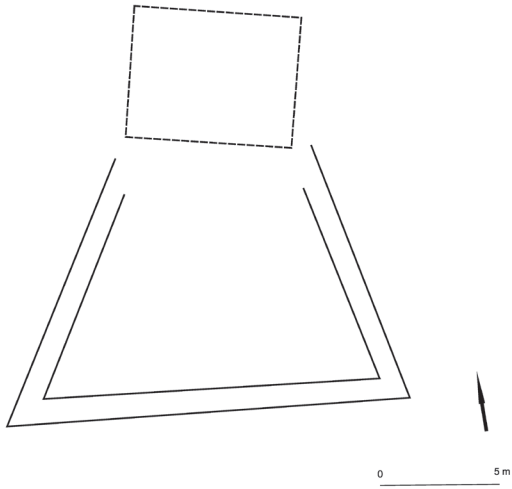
Croquis de planta de la fortificación de Collado del Chacho (Escacena del Campo)
